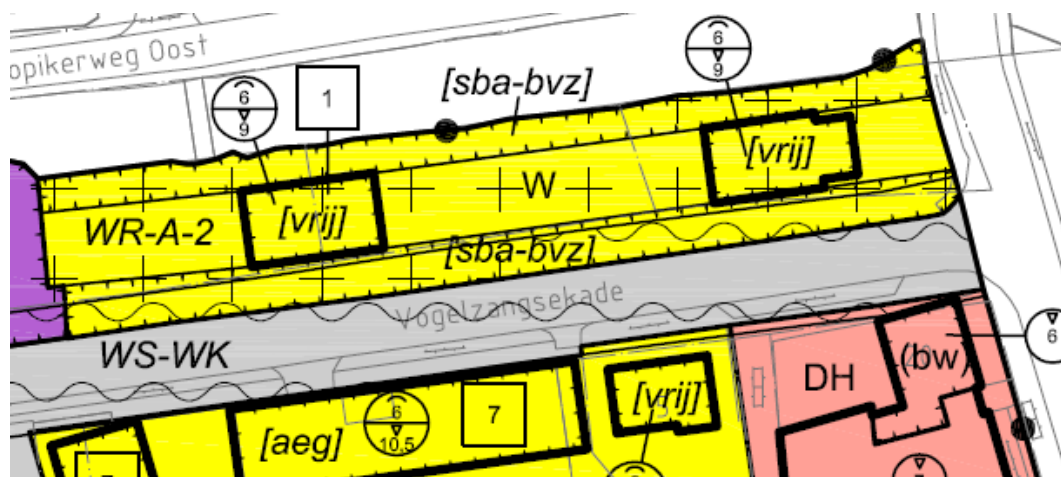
, Ontwerp bestemmingsplan bouwhoogten centrumbestemming
